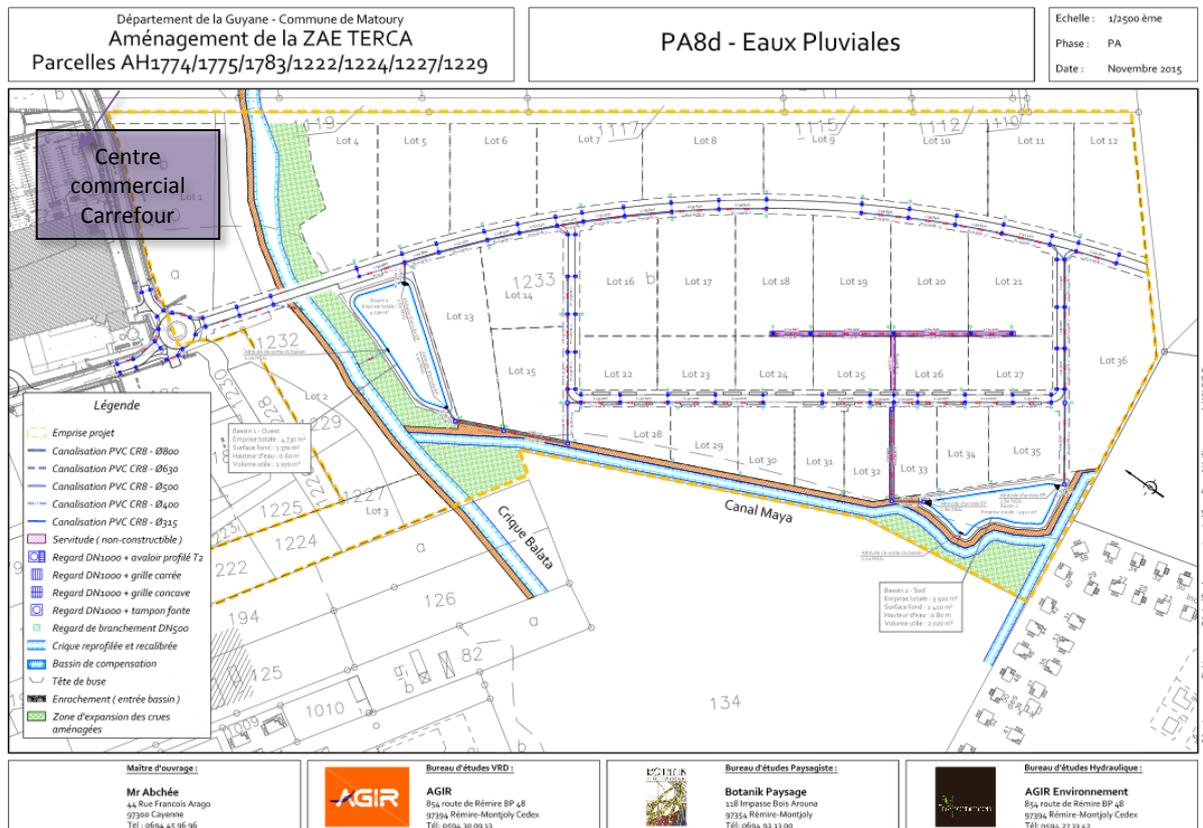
Plan d'aménagement - Extension de la ZAE Terca
